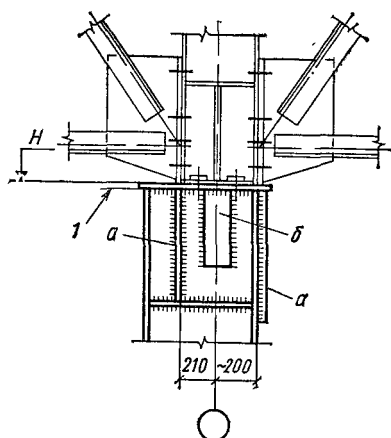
Оголовок колонны среднего ряда краевой здания с проходами вдоль подкрановых путей
